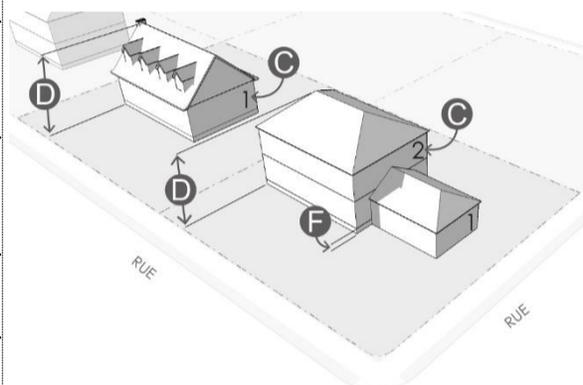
Hauteur d'un bâtiment et du plancher du rez-de-chaussée
